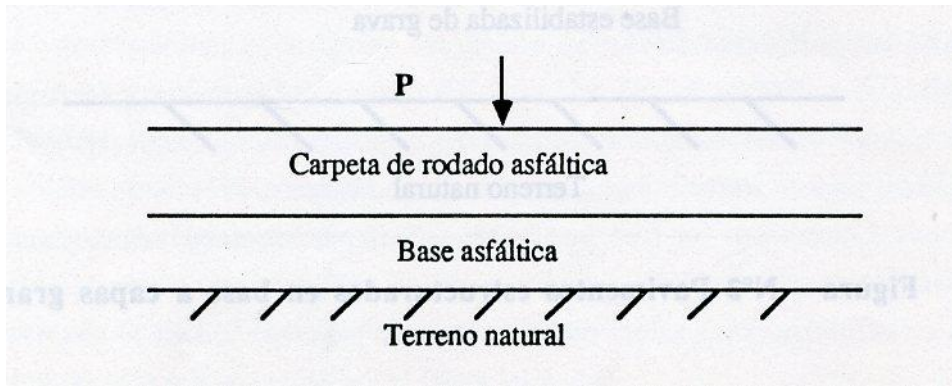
Pavimento estructurado en base a capas asfálticas "Full Depth"
